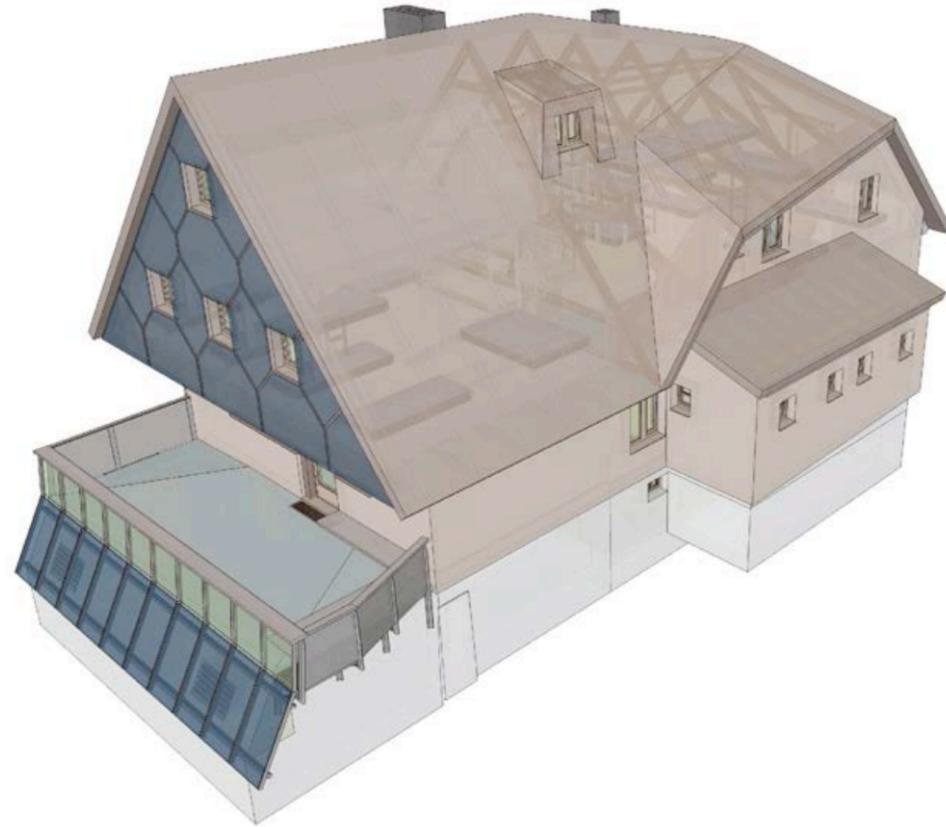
Übersichtsgrafiken zum Innenausbau des Daches, Wärmedämmung, Fenster / Türen und Dachhaut / Photovoltaikfassade
